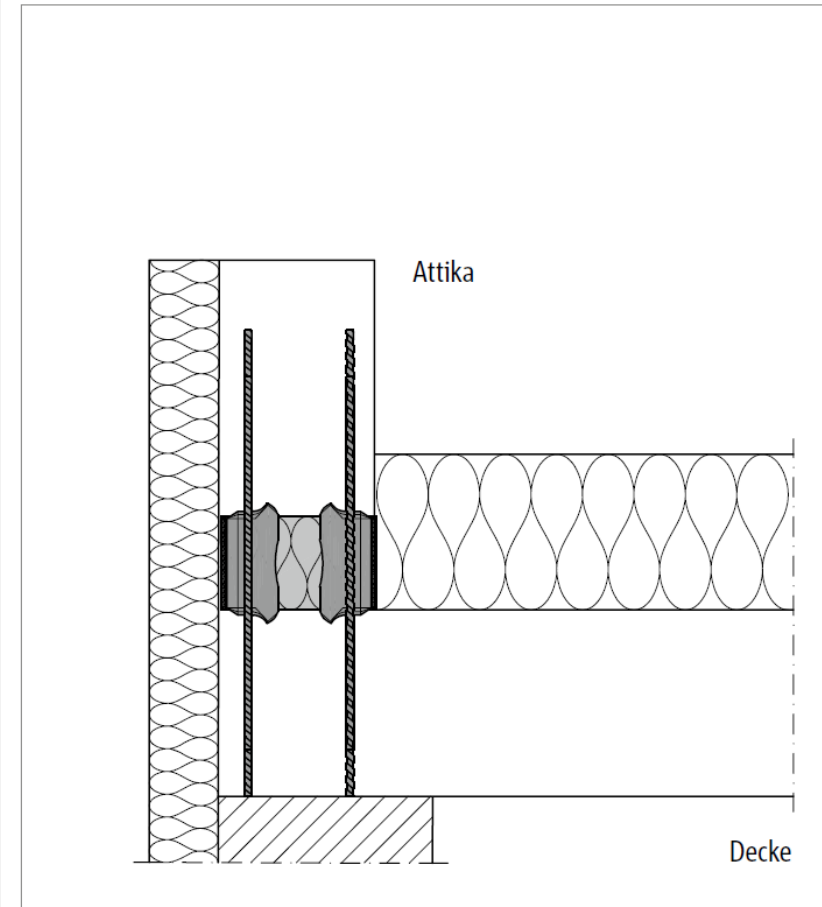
Schöck Isokorb® CXT Typ A: Anschluss einer Attika
